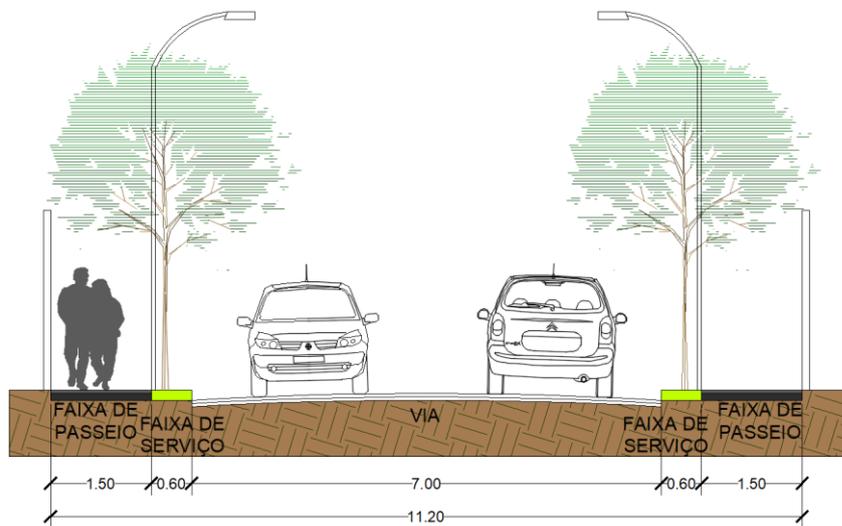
Perfil da Via de Circulação de Vizinhança 2 – Perfil 02 (Fonte: Própria)
